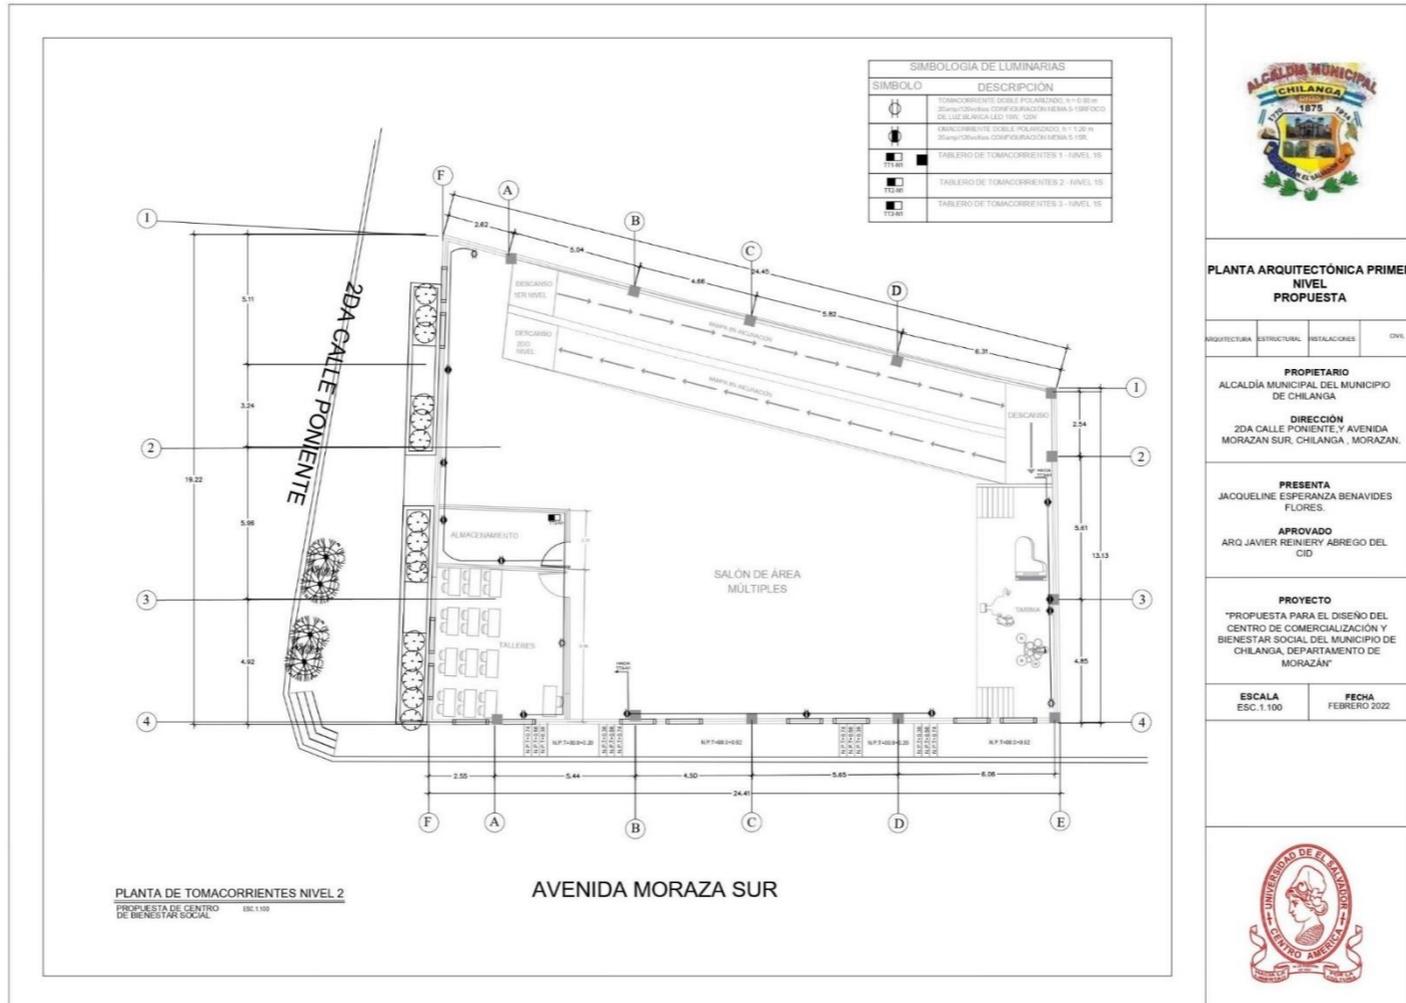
Planta Eléctrica Segundo Nivel Propuesta
